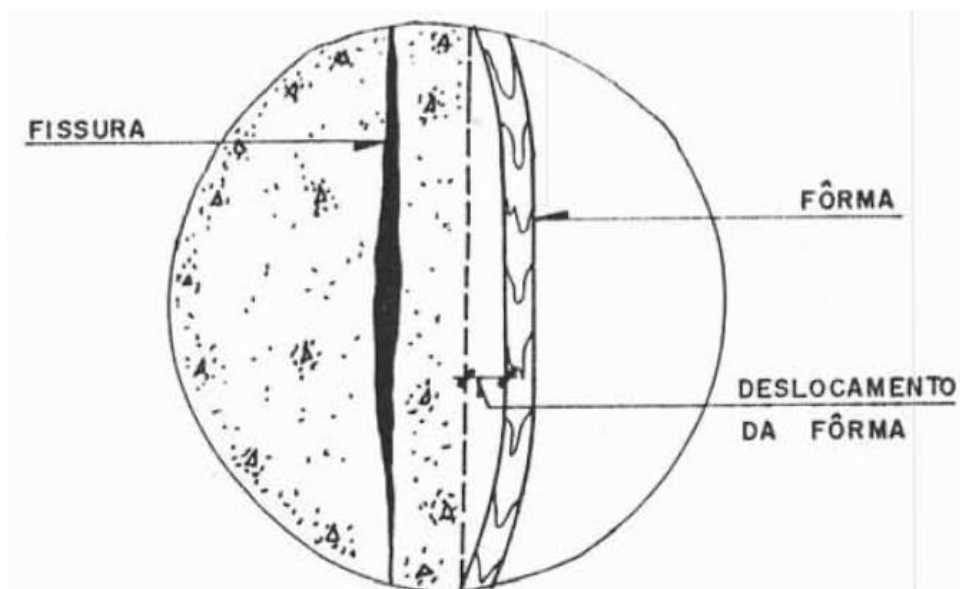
Fissura na superfície do concreto devido ao movimento da fôrma.
